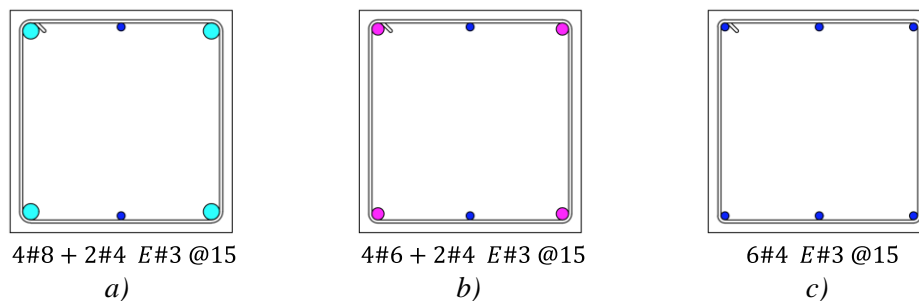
Secciones transversales de columnas: C-1 (a), C-2 (b) y C-3 (c)
